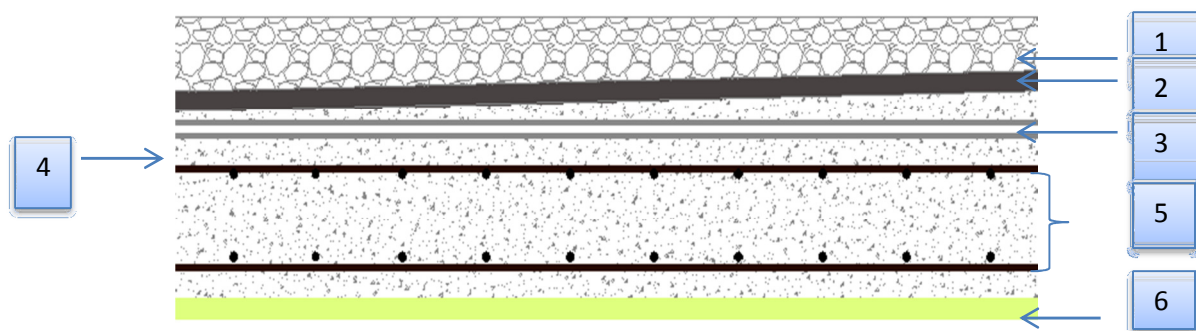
Composants d'un plancher terrasse en dalle pleine.
